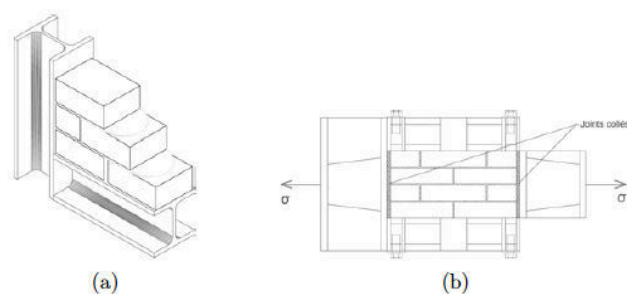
Essai de traction dans la direction parallèle aux joints horizontaux: (a) phase de construction, (b) dispositif de l'essai de traction – Backes (1985)
